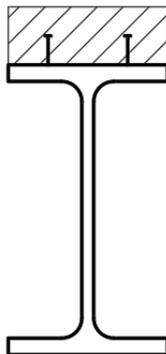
Схема бетонирования сверху верхней полки двутавра
